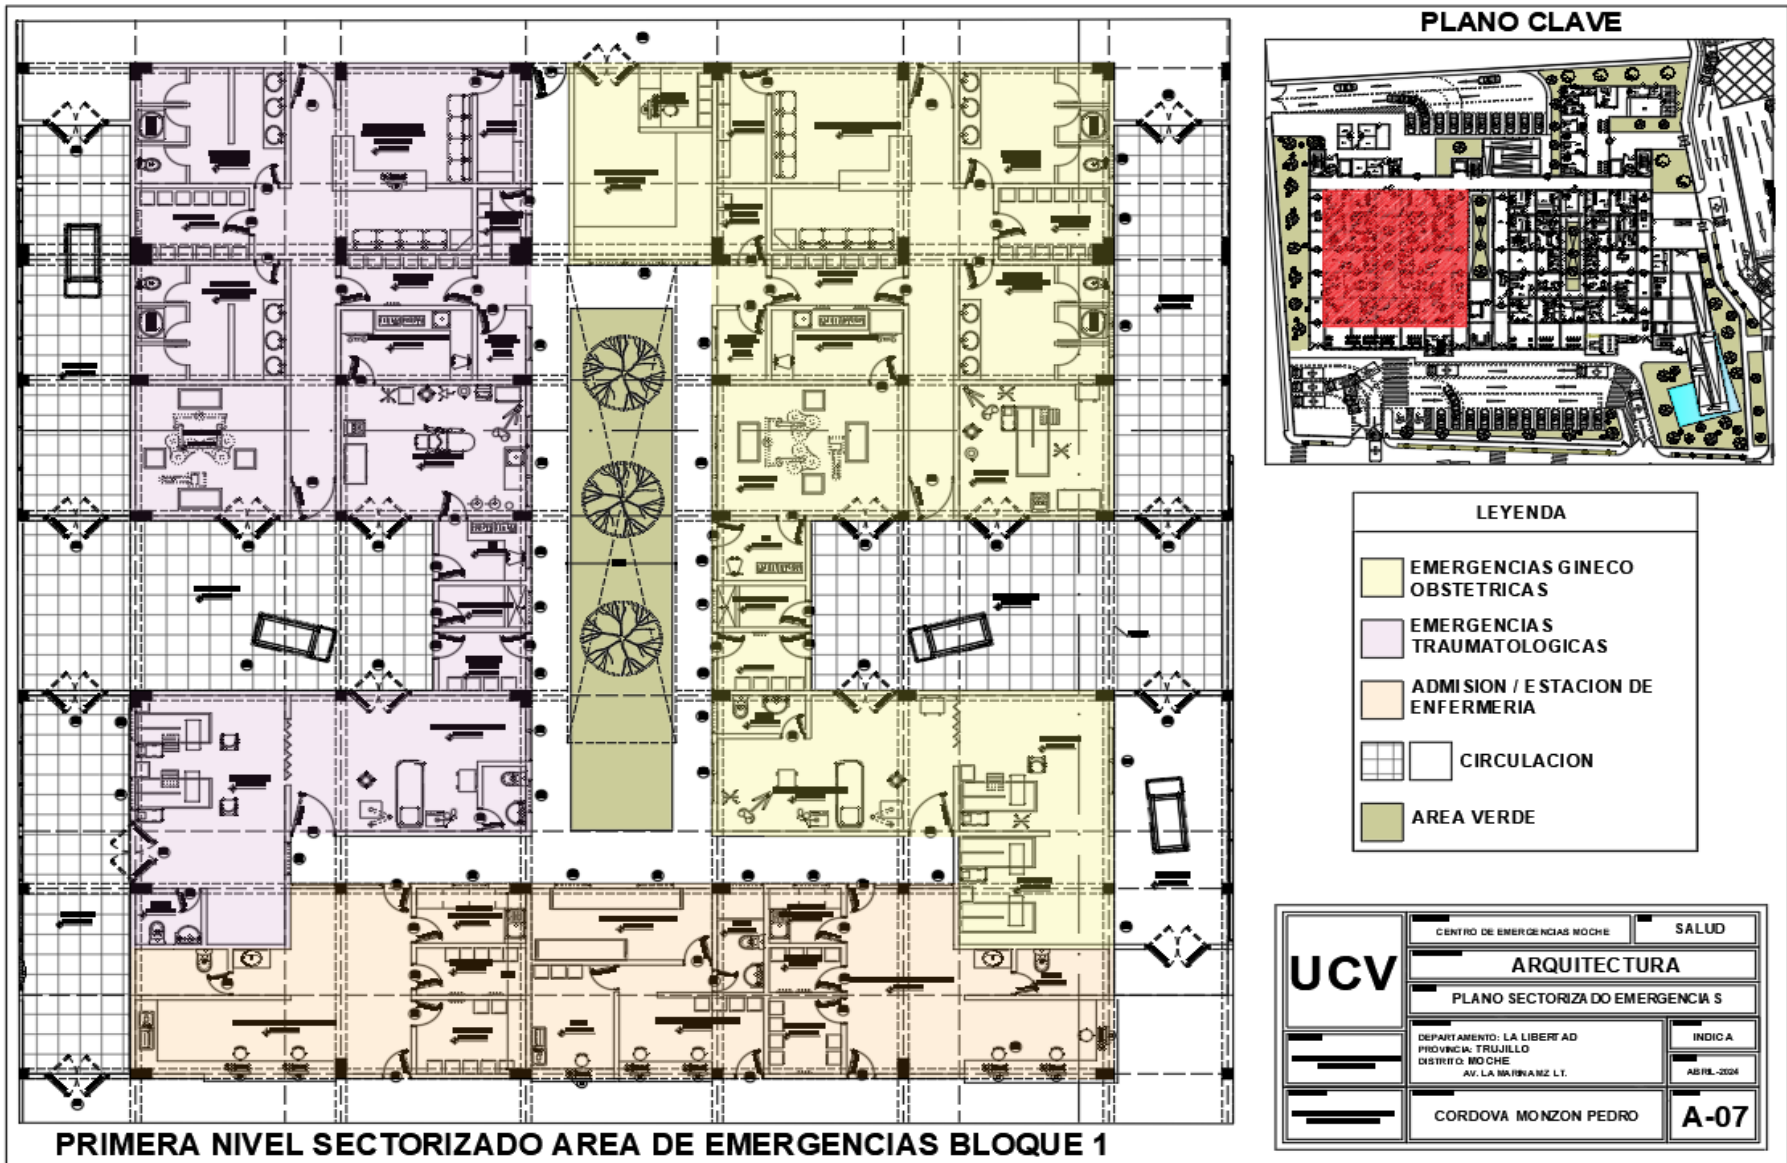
Plano sectorizado de área de emergencias bloque 1
